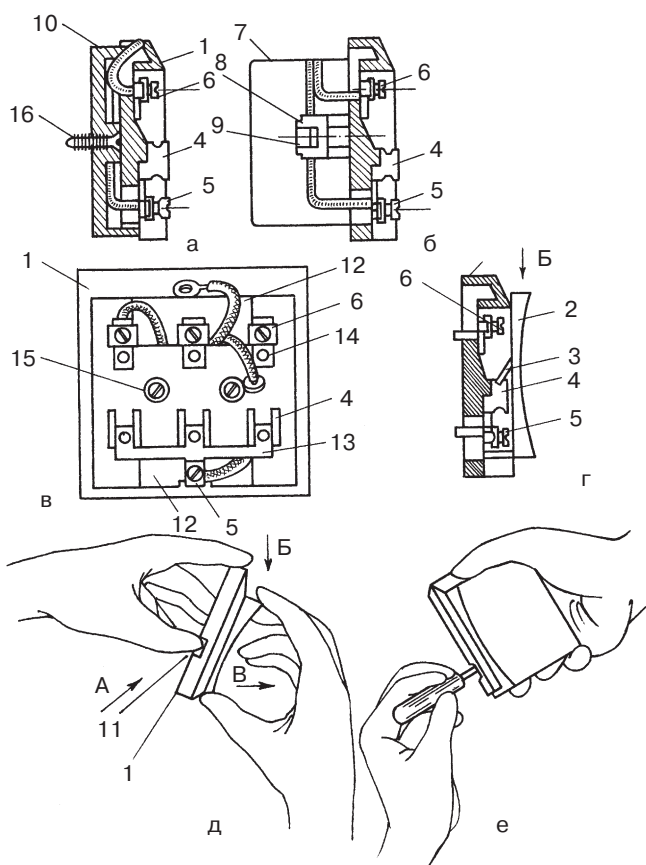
Монтаж выключателей: а — выключатель для открытой проводки; б — выключатель для скрытой проводки; в — выключатель со снятыми клавишами; г, — выключатель с тремя клавишами; д — снятие клавиши выключателя; е — смещение фиксатора при смонтированном выключателе; 1 — основание выключателя; 2 — клавиша выключателя; 3 — вилка клавиши; 4 — стойка; 5, 6 — винты; 7 — коробка для утопленного монтажа; 8 — резинка; 9 — распорные лапки; 10 — монтажное основание; 11 — поводок фиксатора; 12 — окна; 13 — мостик; 14 — неподвижные контакты; 15, 16 — винты
